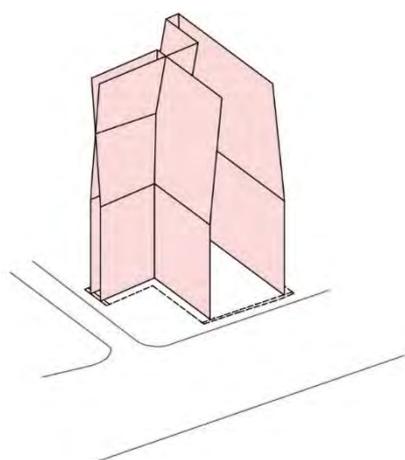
Diagrama pavimento térreo: Fachada Ativa em duas testadas e fruição descoberta
